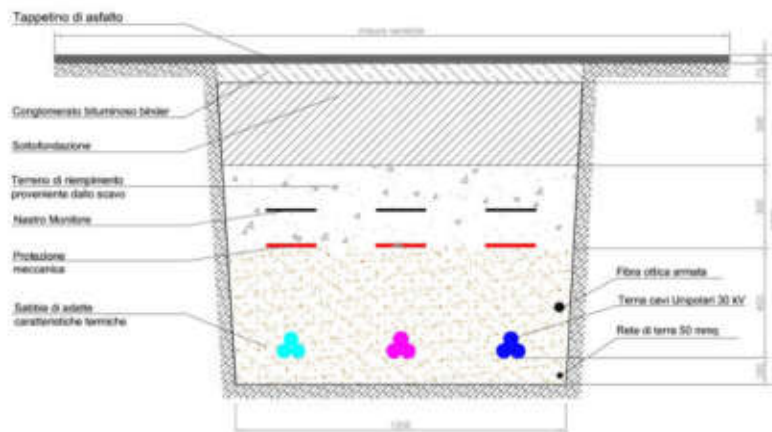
Particolare Posa del cavidotto all'interno del manufatto stradale
